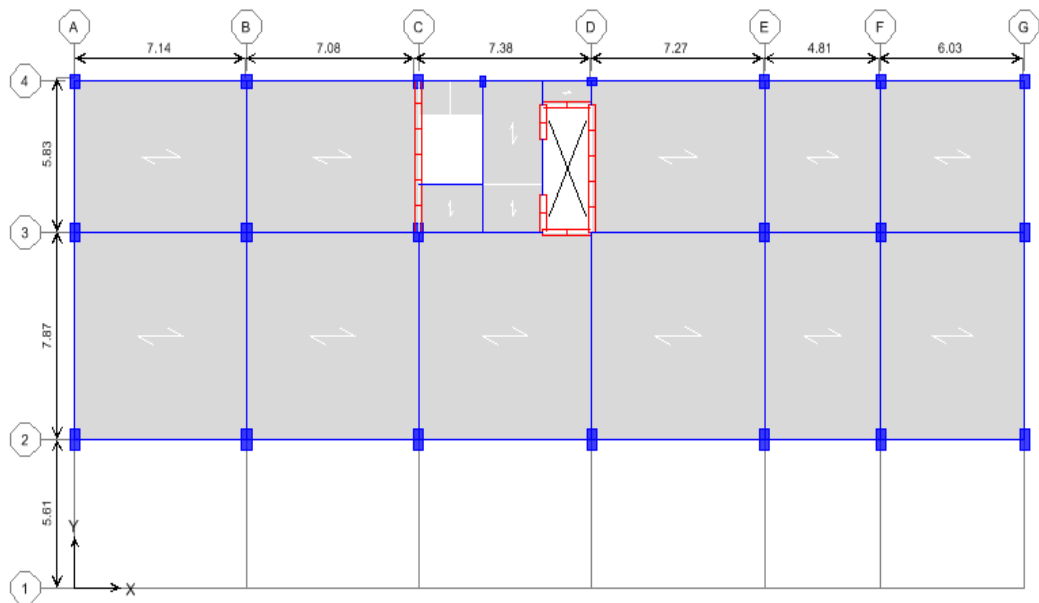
Planta estructural típica del 4to. al 8vo. Piso
